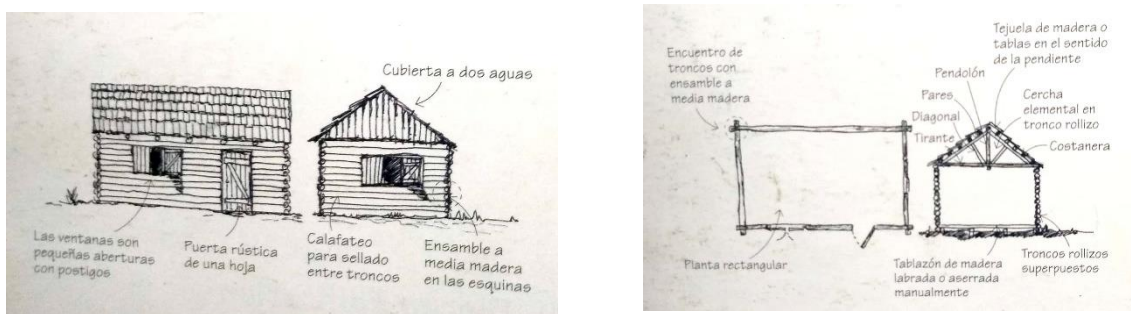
y 12: Sistema constructivo de madera con solución simple de planta rectangular y techumbre a dos aguas
